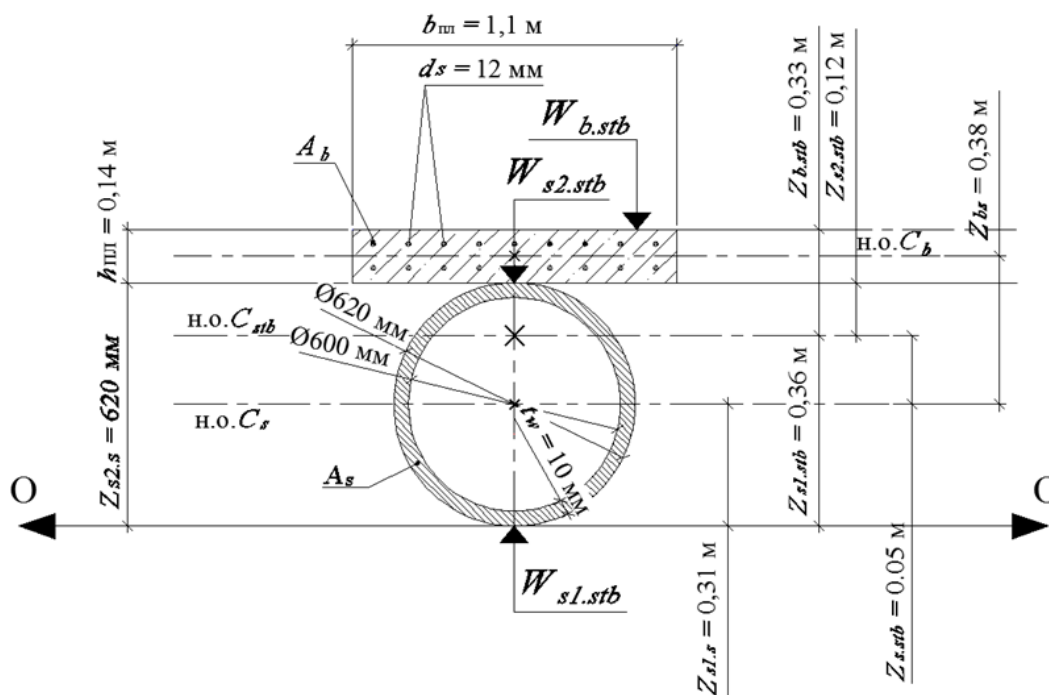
Расчетная схема сталежелезобетонного сечения для расчета геометрических характеристик
